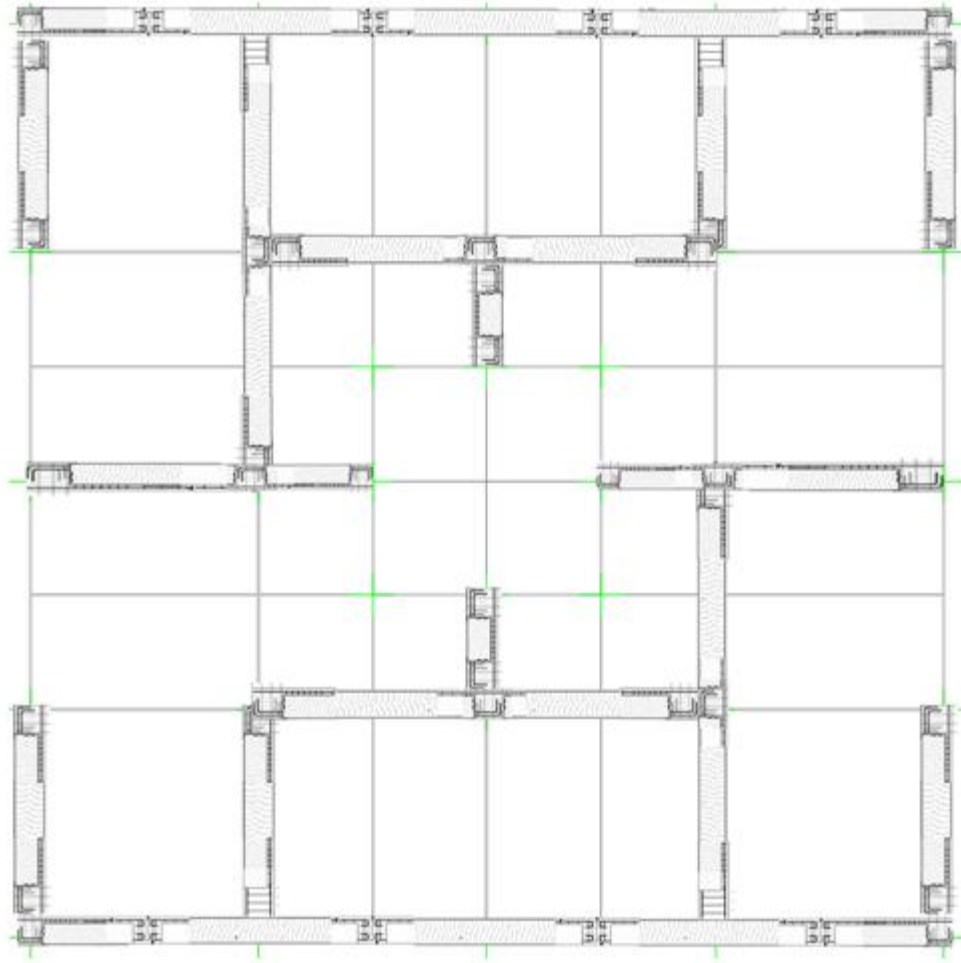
Diagrama de elementos y conexiones en planta para ambas edificaciones.
